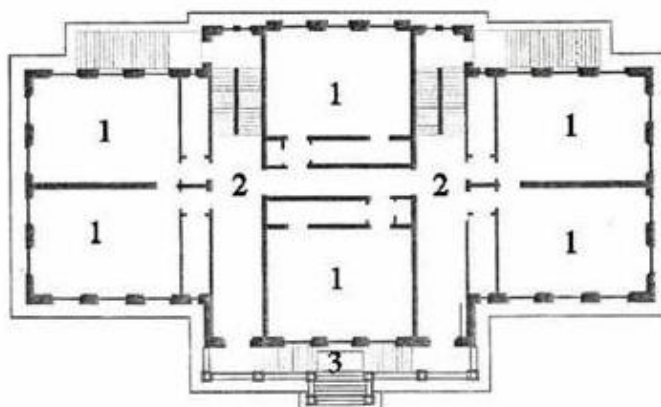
Planta baixa pavimento térreo da Escola Modelo da Luz (1897), São Paulo.
